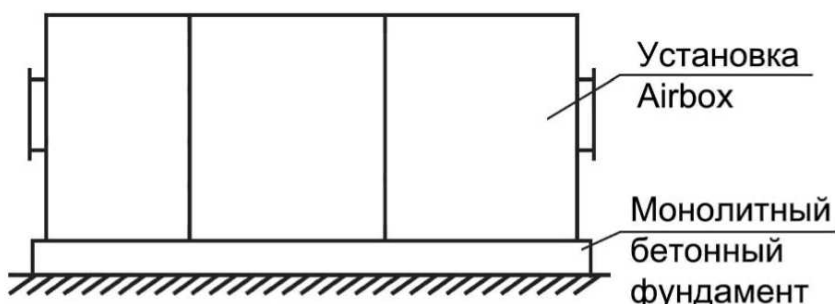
Монолитный бетонный фундамент для установки под сифоном.
